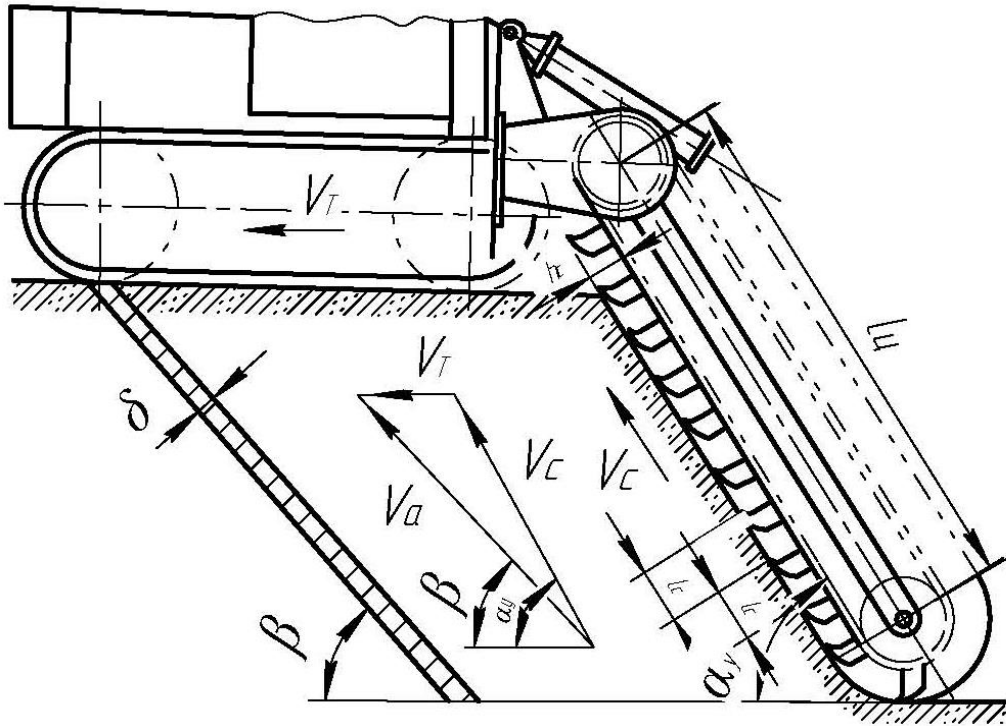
Схема машины со скребковым рабочим органом продольного копания, разрабатывающим грунт по совмещенной схеме (тип 4)
